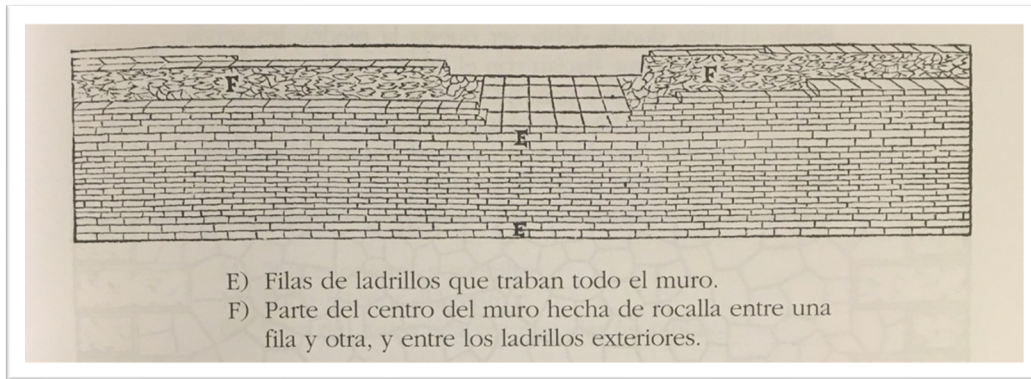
Sistema constructivo para muros de ladrillos a tizón y sogá con centro de rocalla o ladrillo machacado.
